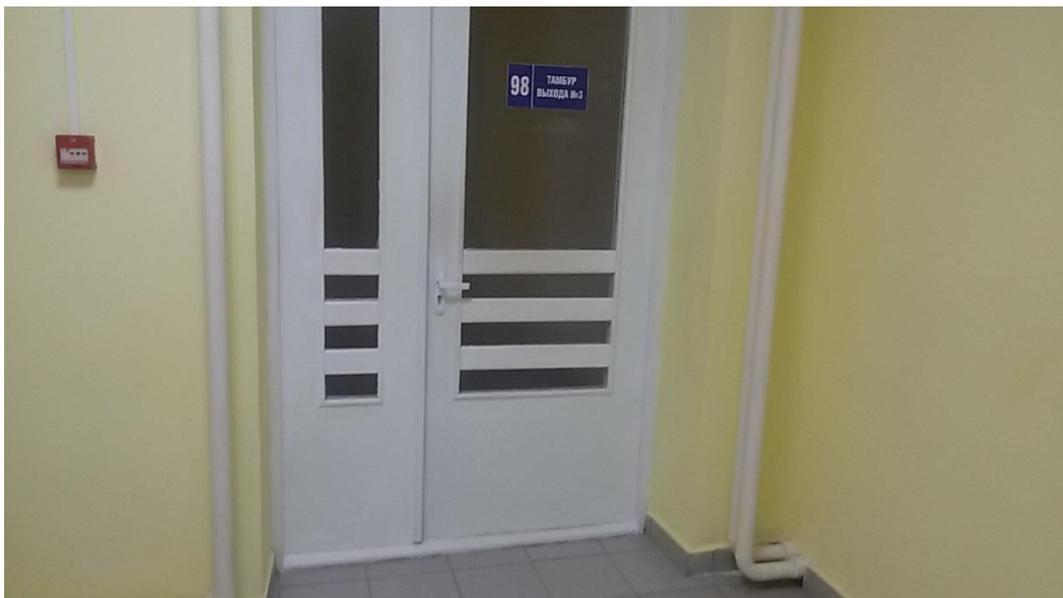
Дверь (выход на балкон в пожаро-безопасную зону)
